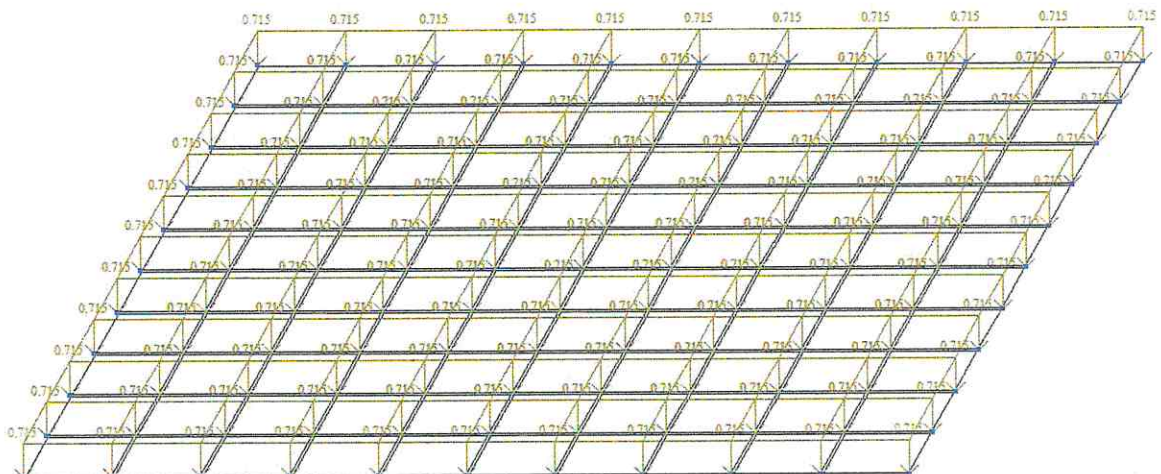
Нагрузка на плиту перекрытия лифтовой шахты от собственного веса плиты перекрытия.
